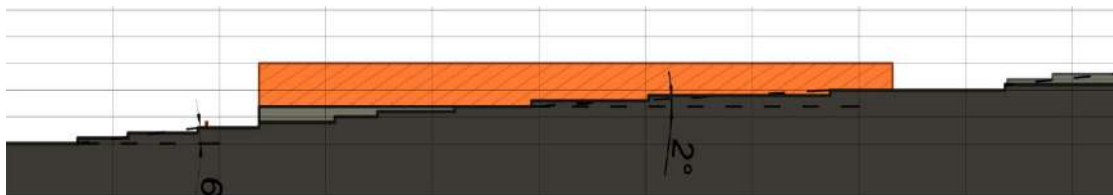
Corte esquemático del emplazamiento del terreno – Propuesta Arquitectónica. Fuente: Elaboración Propia.
